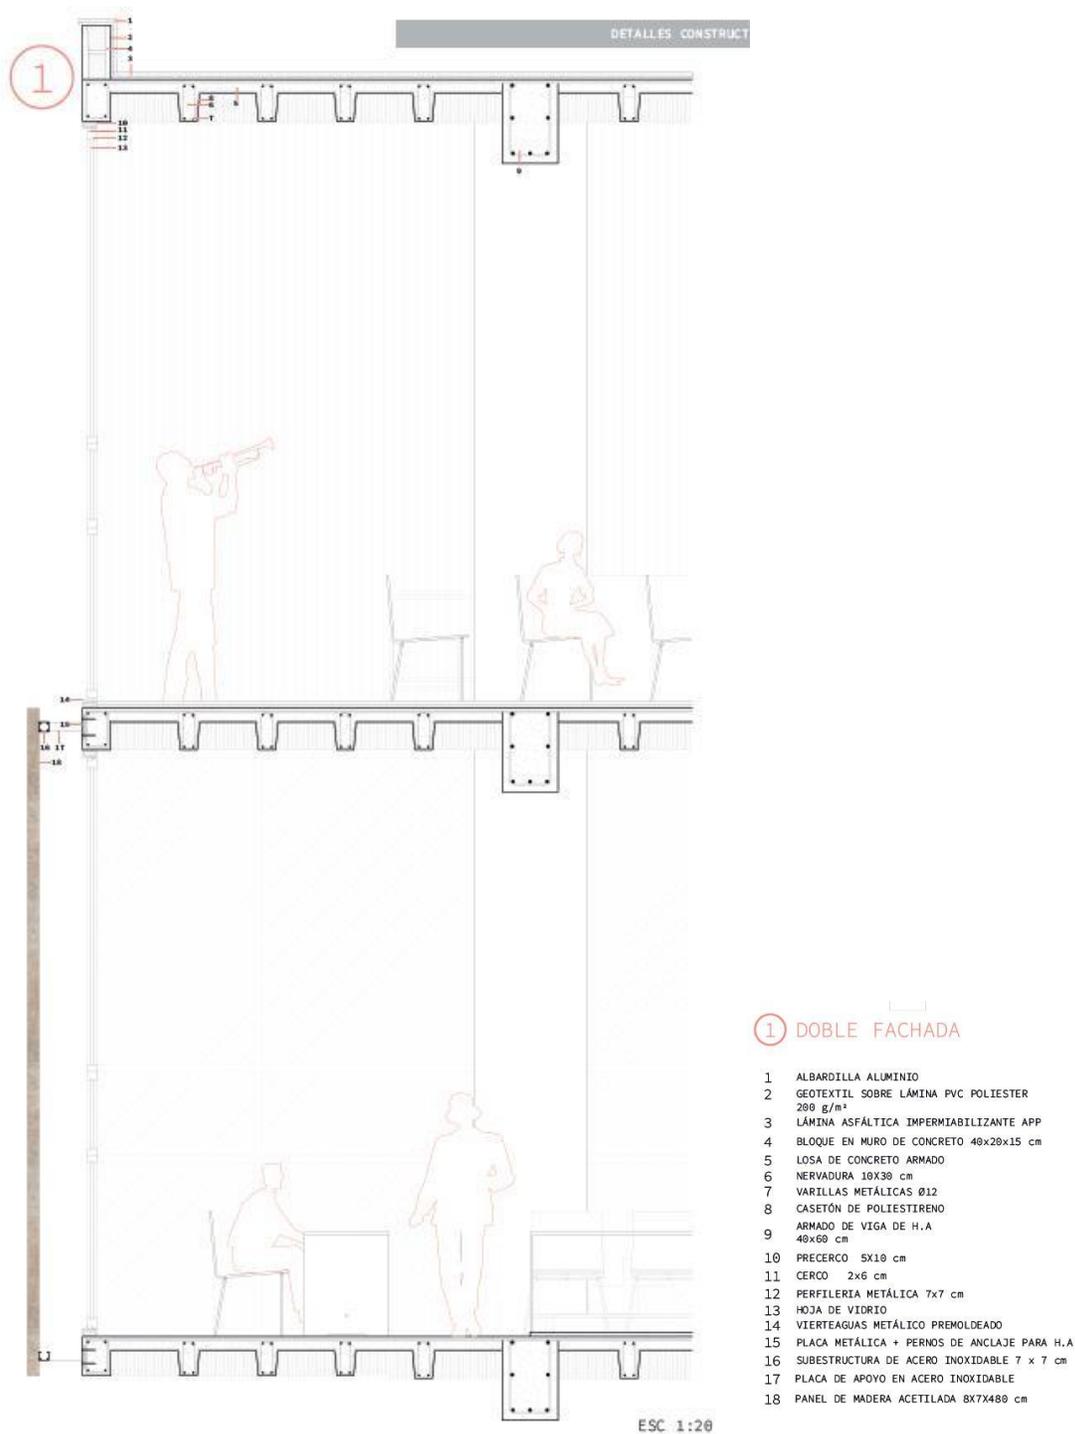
Detalle constructivo fachada doble. Elaboración propia.
